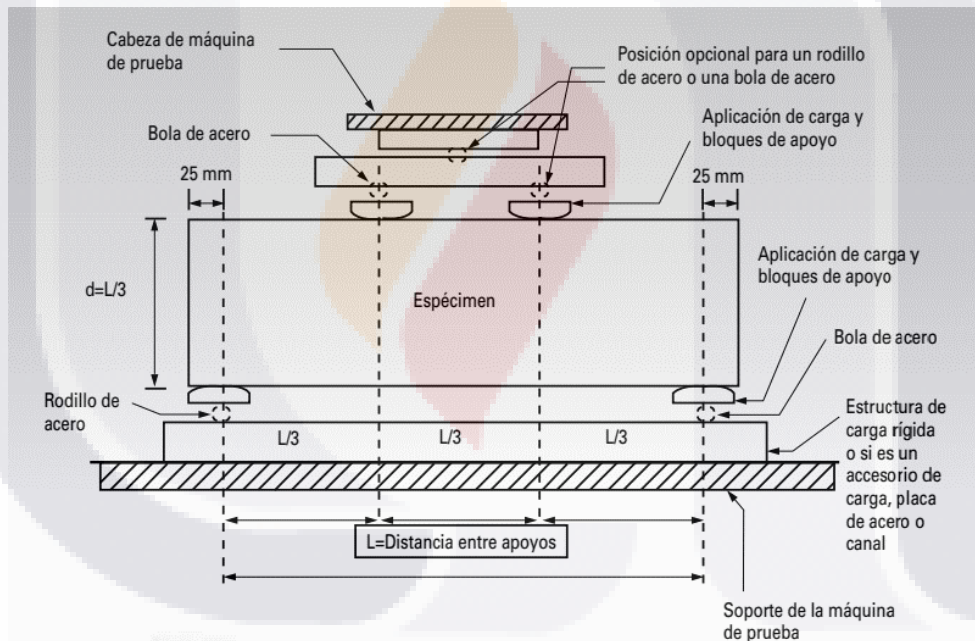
Modo de colocación de las vigas para la prueba de flexión (IMCYC, 2008).
